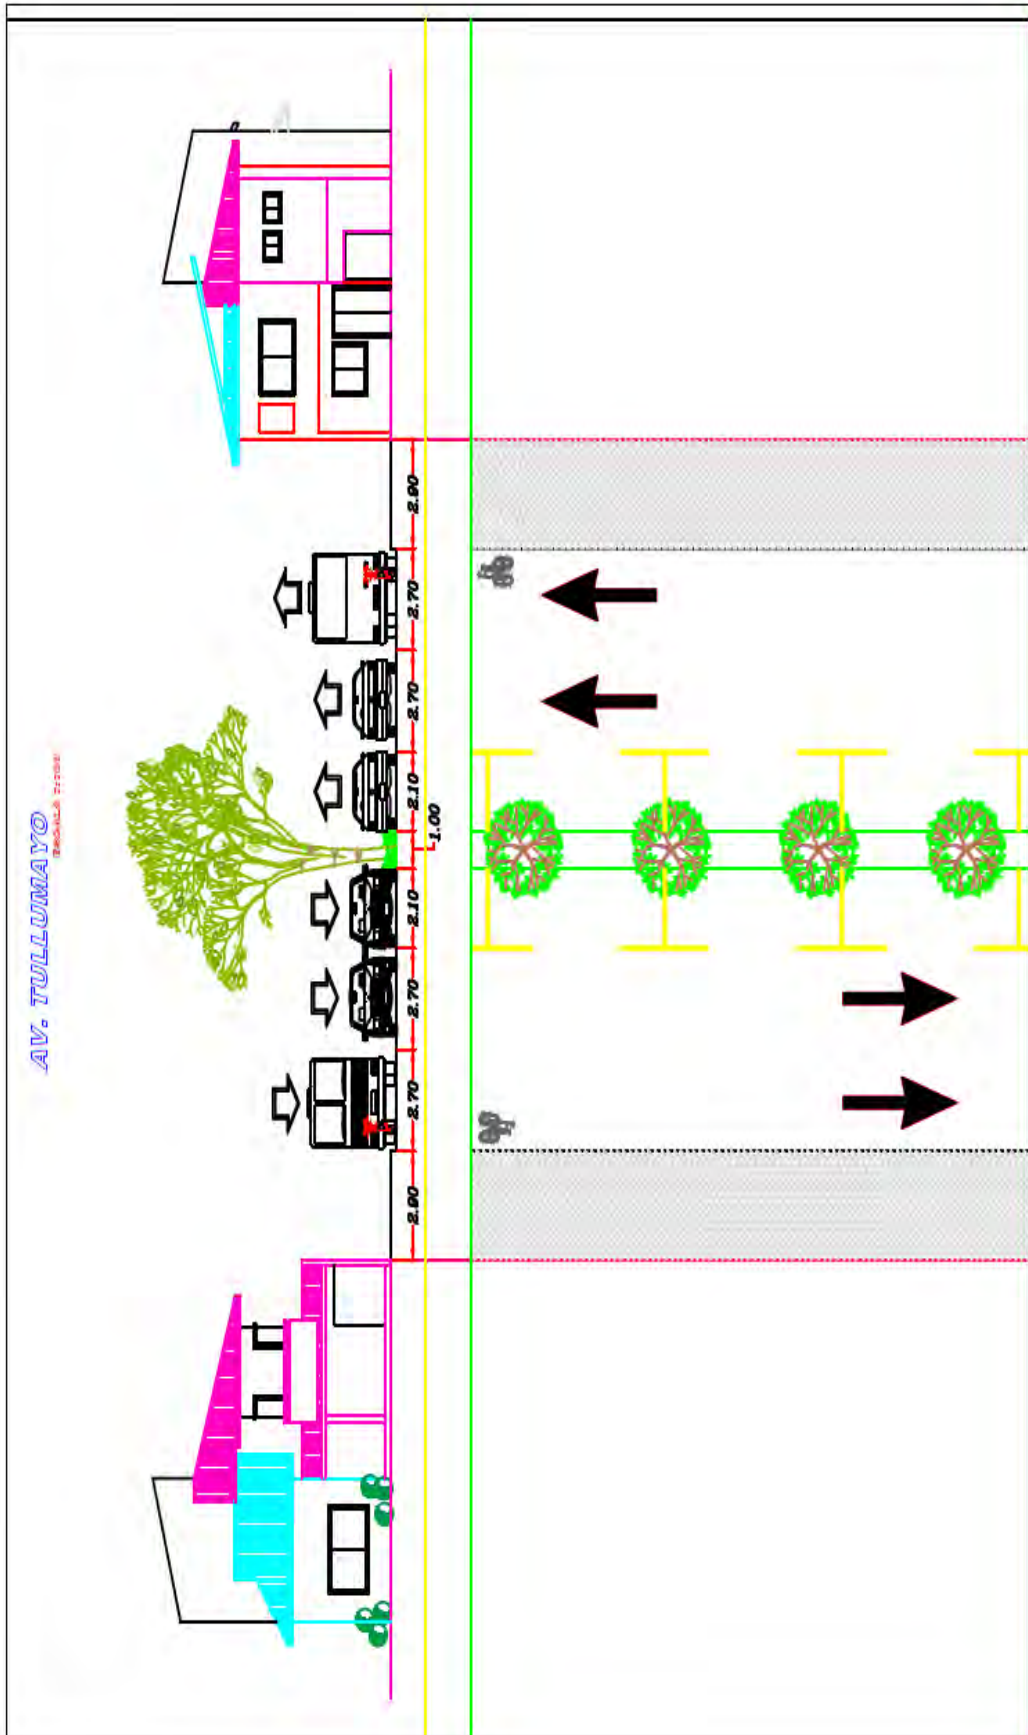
Propuesta Sección Transversal Av. Tullumayo.
